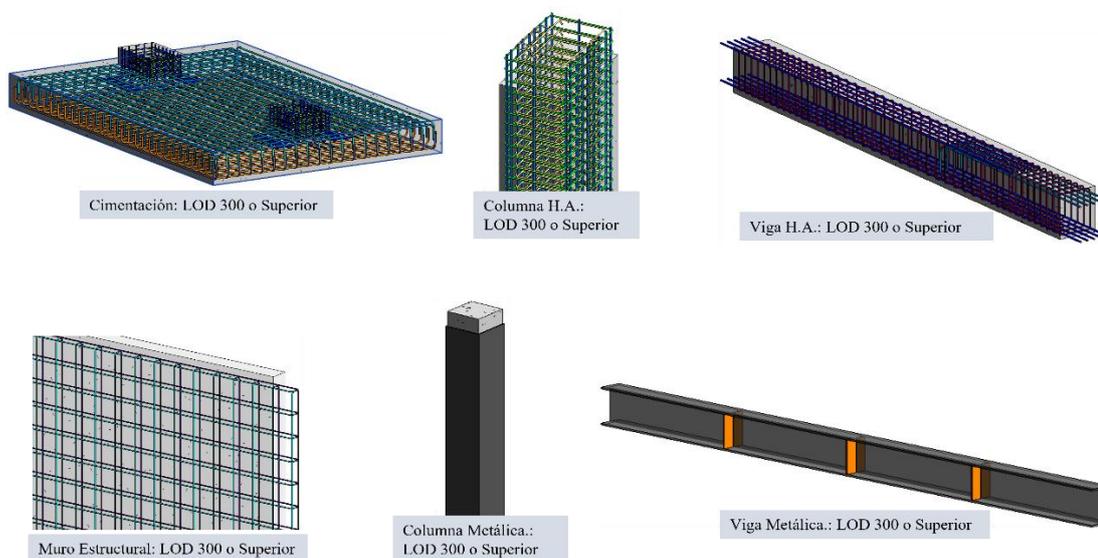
Nivel de Detallamiento Gráfico de Elementos Estructurales
